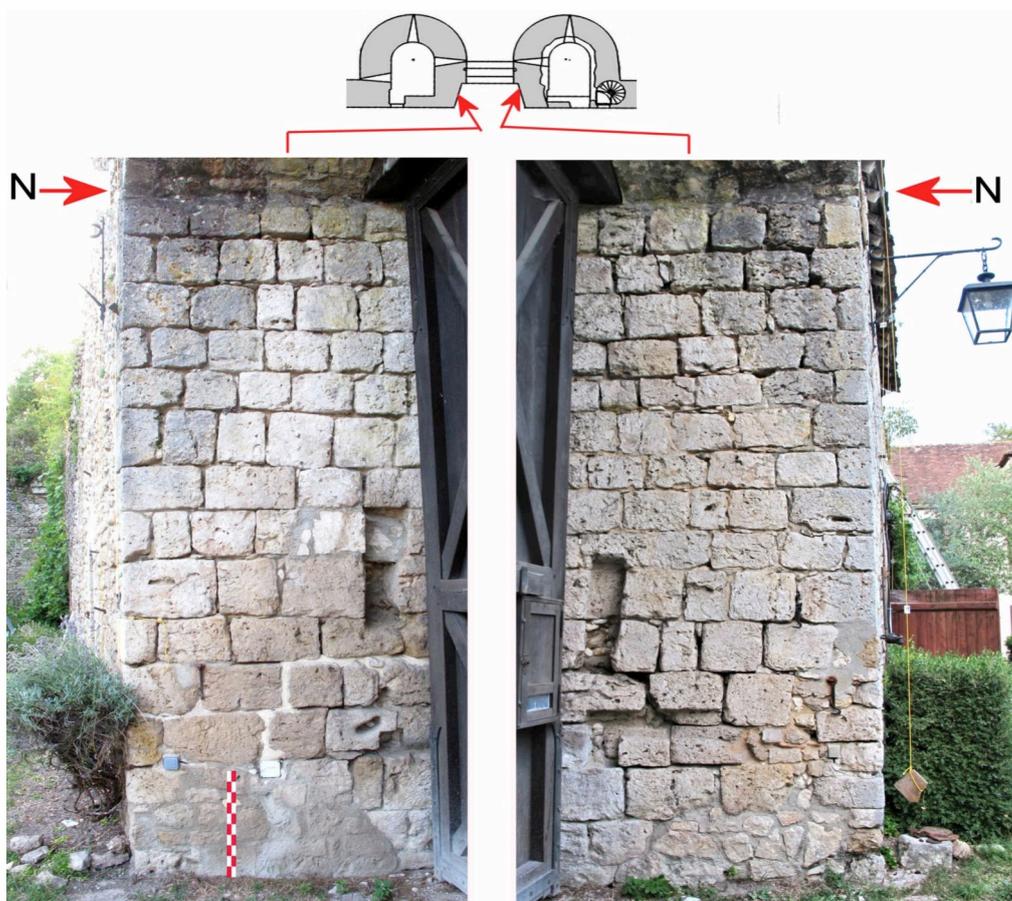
Porte P1 - Tableaux intérieurs d'ébrasement avec encoches de barres de verrouillage (Photo : Michel Piechaczyk / ADM).
